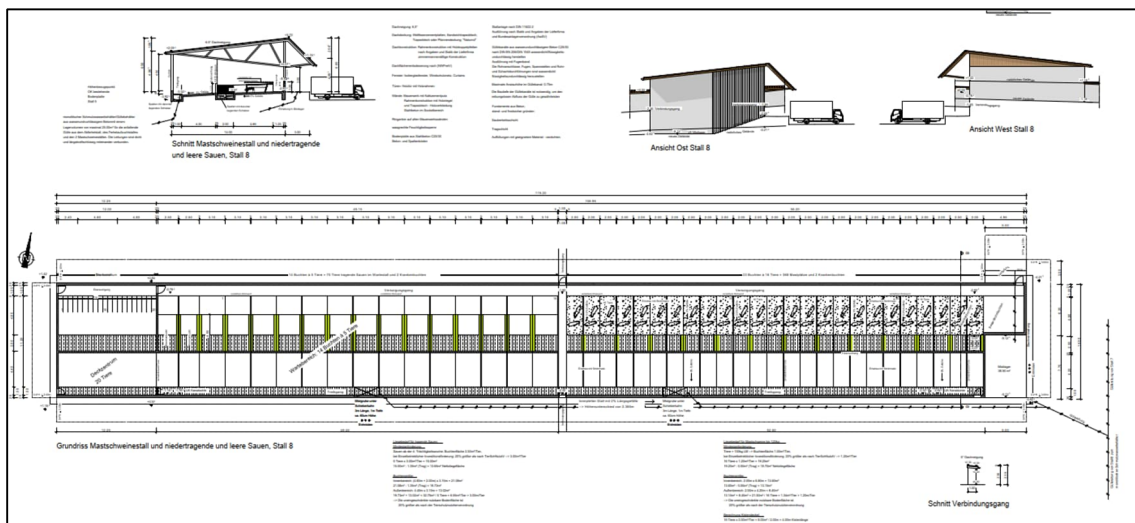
Grundriss und Schnitt von Stall 8 (Quelle: BBV Landsiedlung GmbH)
